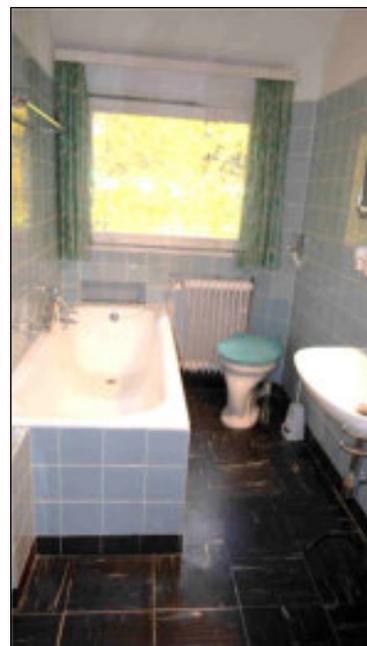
Innenansicht Dachgeschoss Haus 93 (Beispiel)
